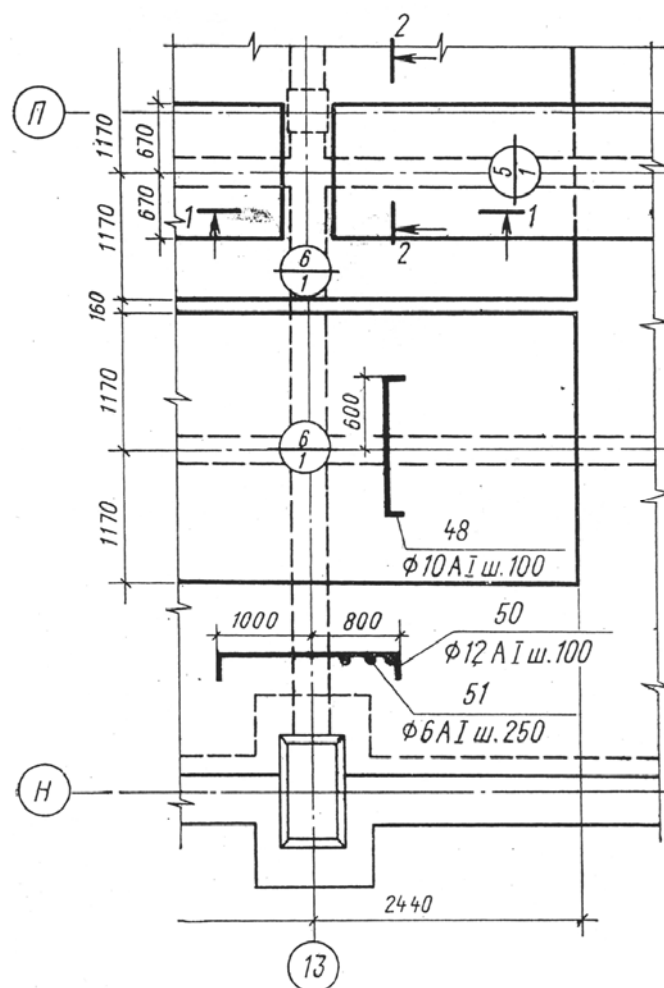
Раскладка верхних арматурных сеток Пм1
